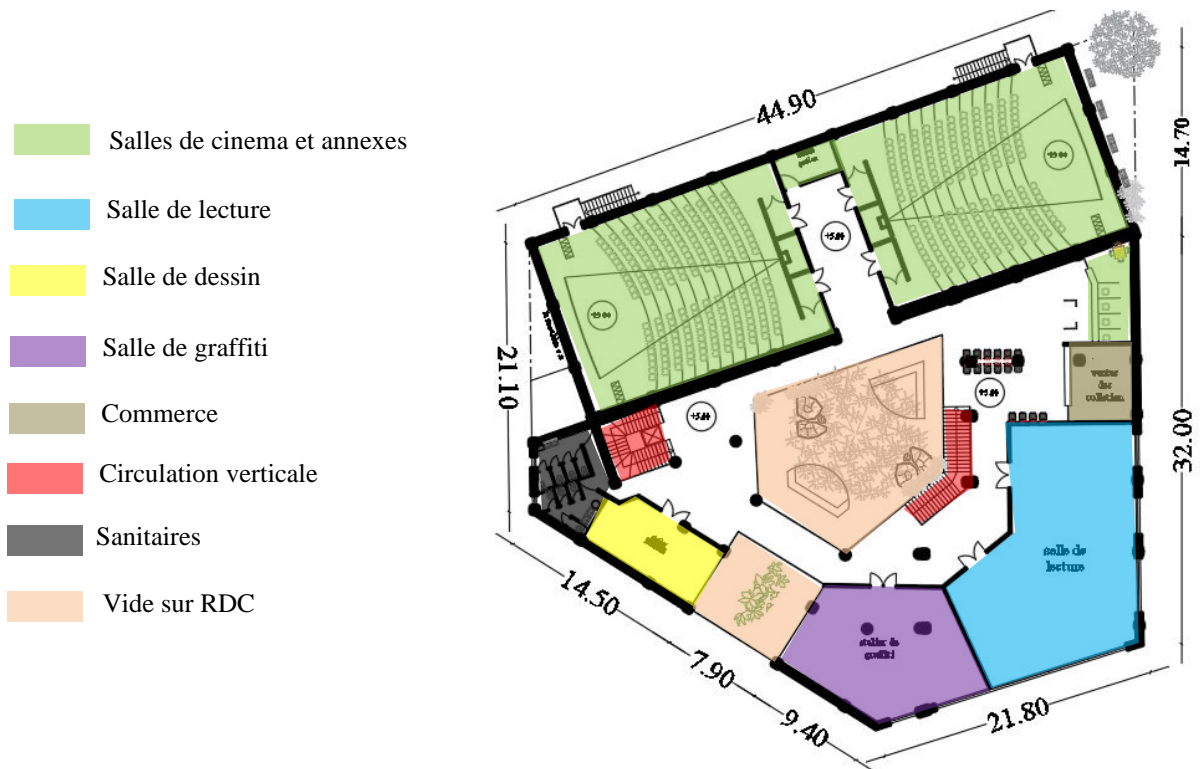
Plan R+1 Culture. (Source : Auteur)
